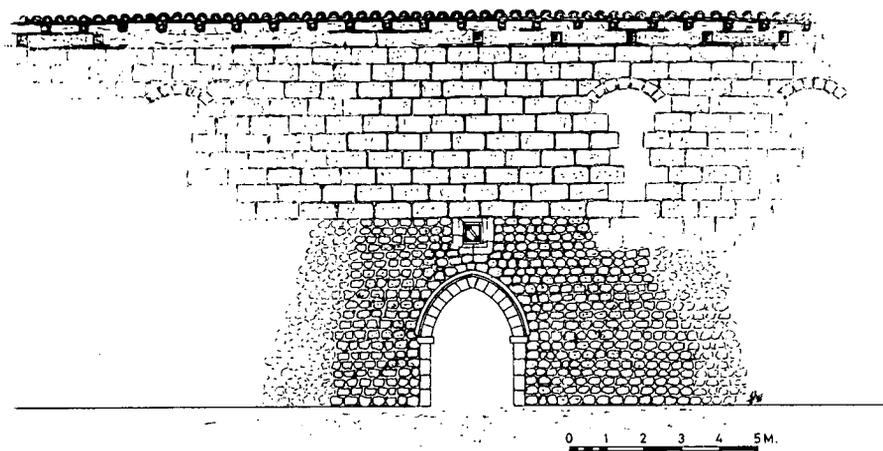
Reconstrucción de una parte de la fachada, atendiendo a los elementos conservados.
